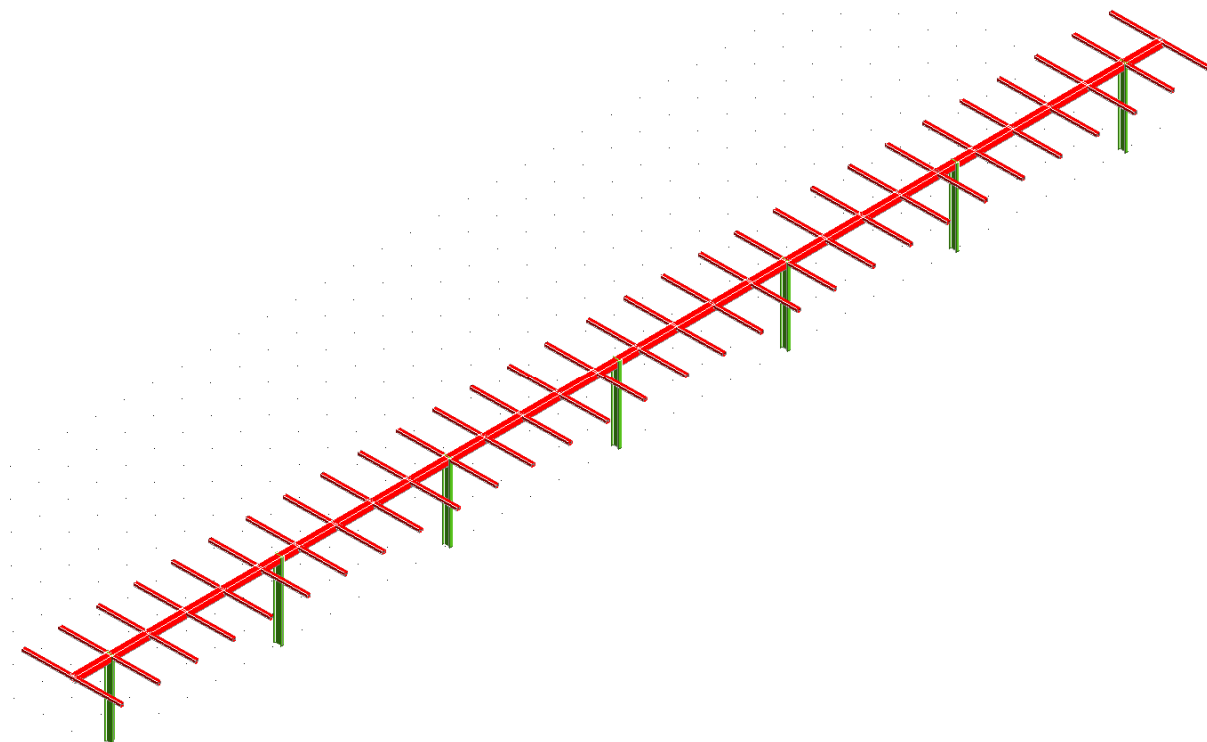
Vista assonometrica modello strutturale con posizione della “vela” orizzontale
